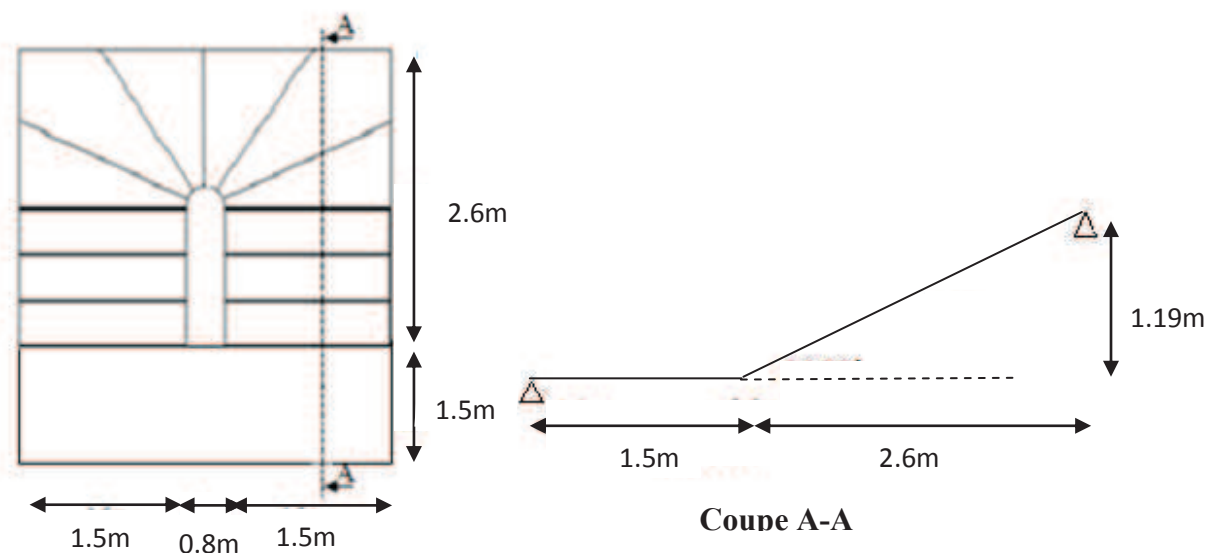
Vue en plan du 2^{ème} type d'escalier
